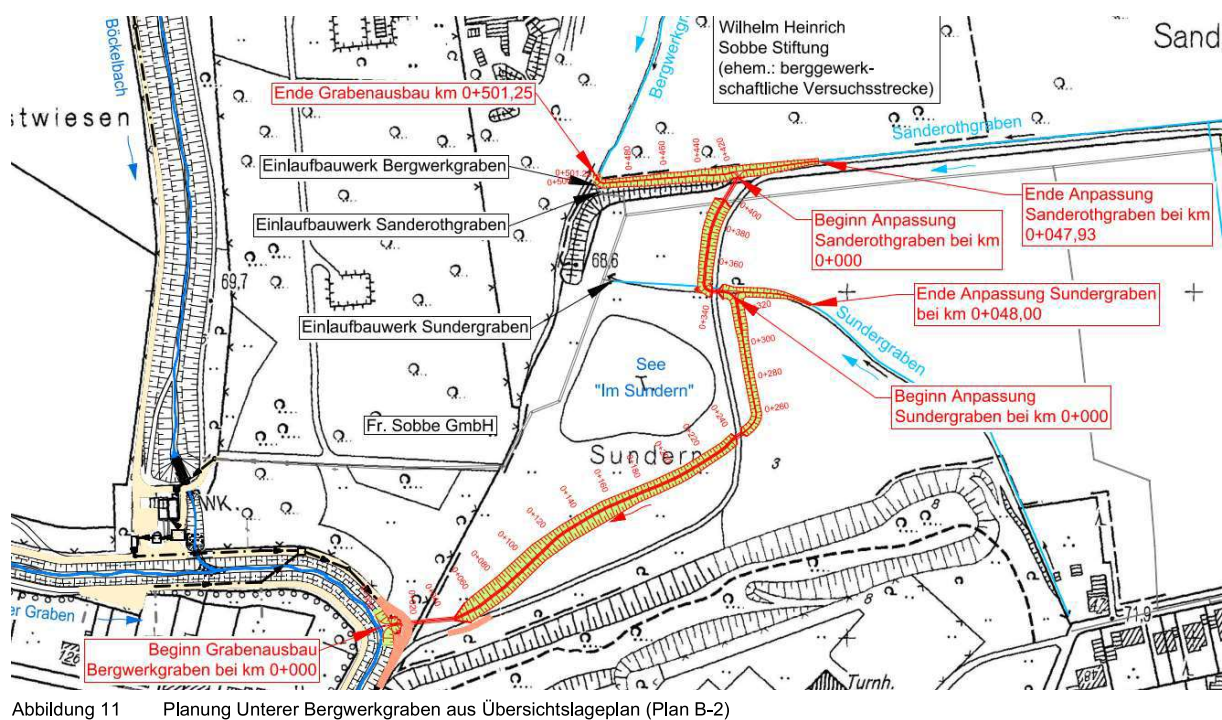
Planung Unterer Bergwerkgraben aus Übersichtslageplan (Plan B-2)
